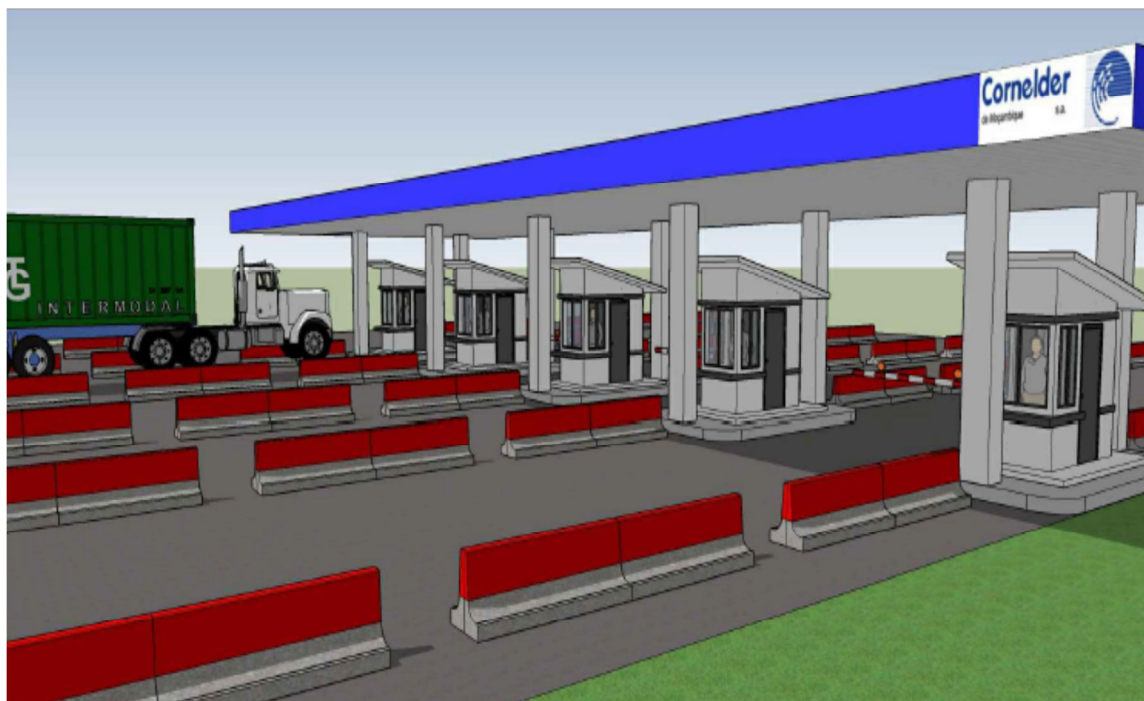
Pormenor em 3D do alpendre para as cabines de atendimento
